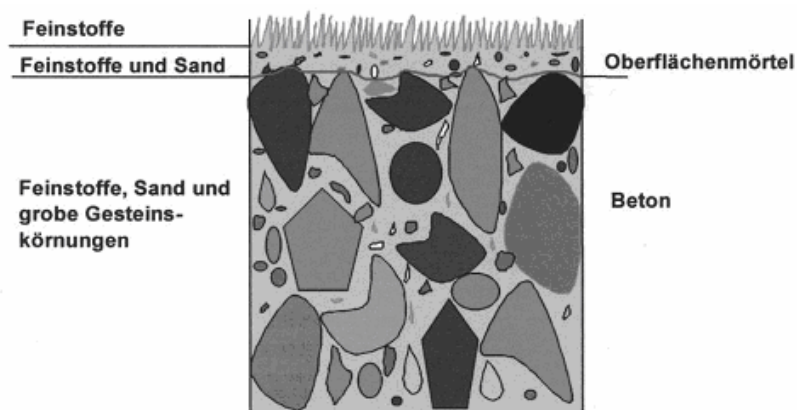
Aufbau und Bezeichnung der oberen Zonen einer Betonfahrbahndecke nach der Herstellung aus [8], [9]
